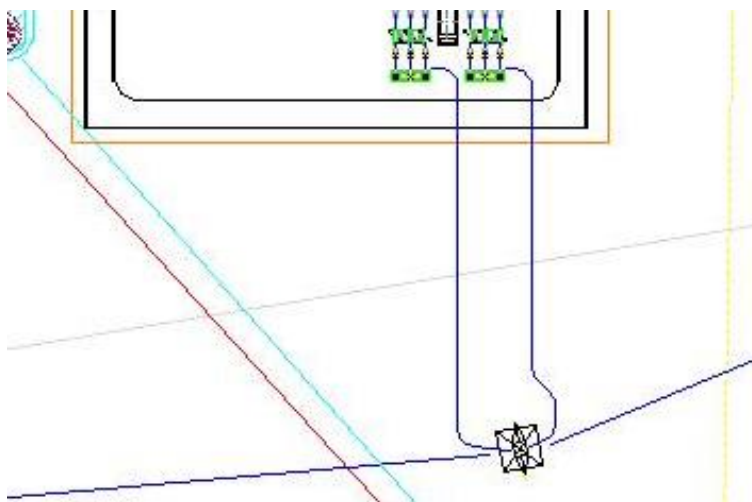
Layout dei collegamenti in cavo verso Stazione TERNA
